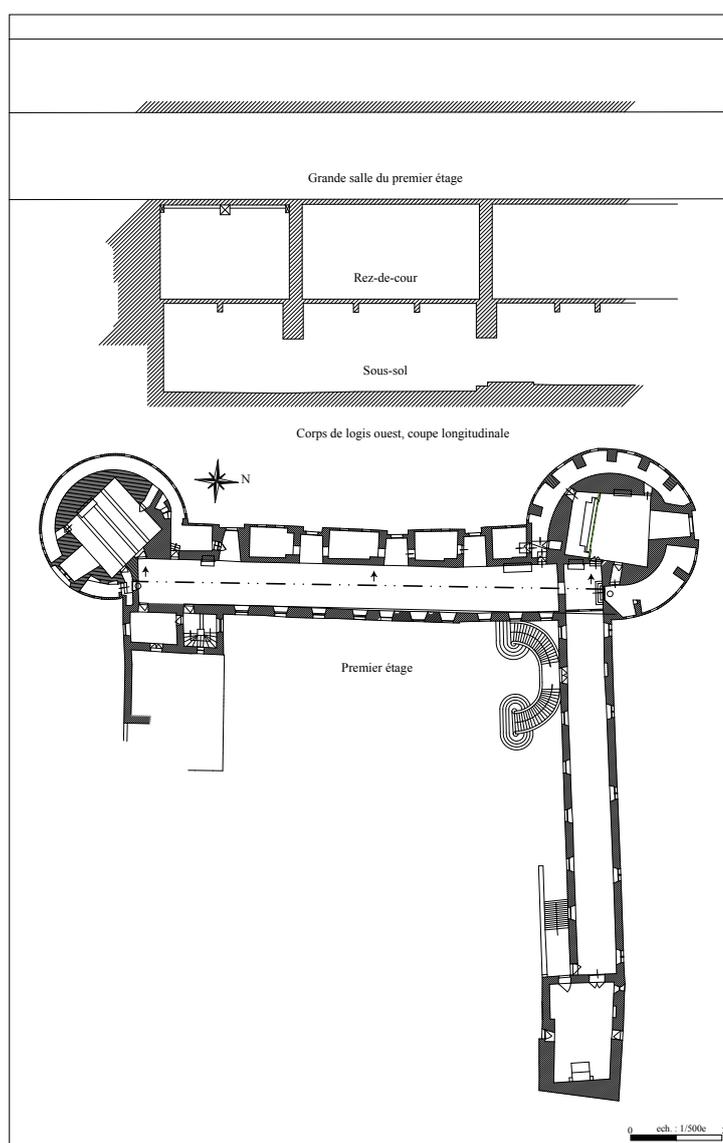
Pontivy, plan de l'étage et coupe du logis ouest (DAO Jocelyn Martineau, 2009, d'après plan topographique levé par la ville de Pontivy, 2002)
